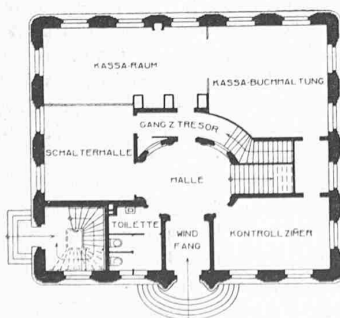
Erdgeschoss. — Masstab 1 : 400. —
